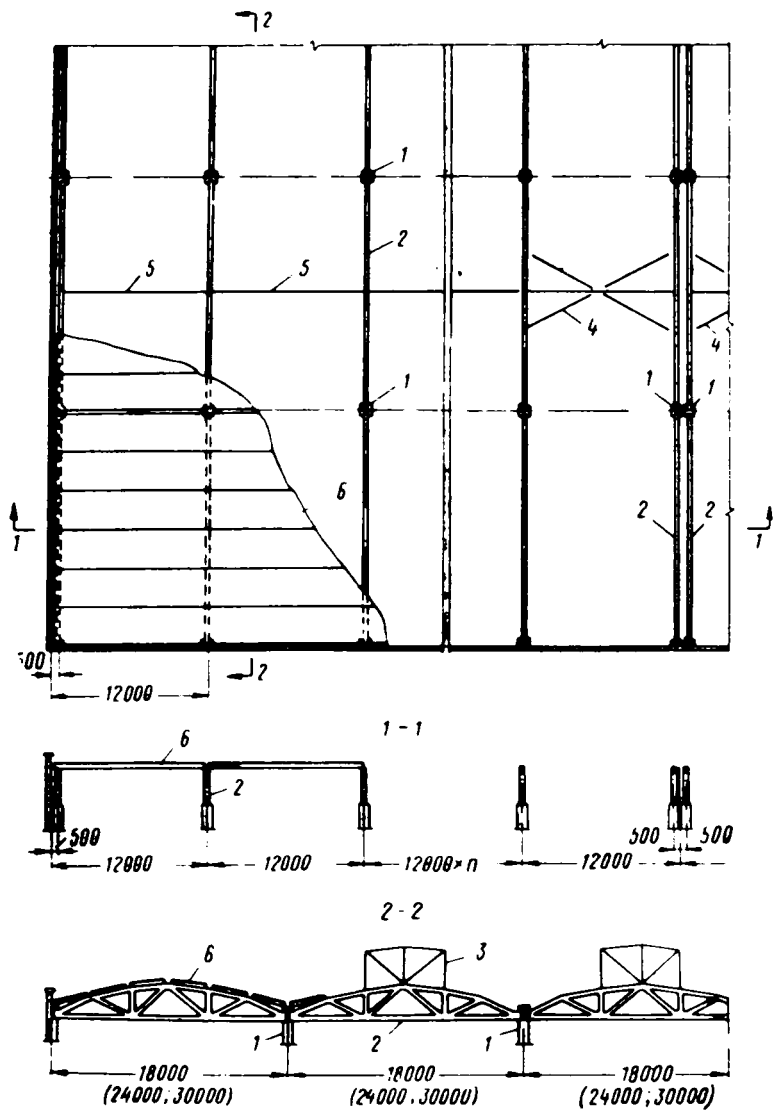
Конструктивная схема II покрытия зданий со скатной кровлей при шаге колонн и стропильных конструкций 12 м
